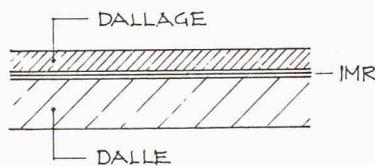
IMR sur la dalle d'un sous-sol non chauffé
